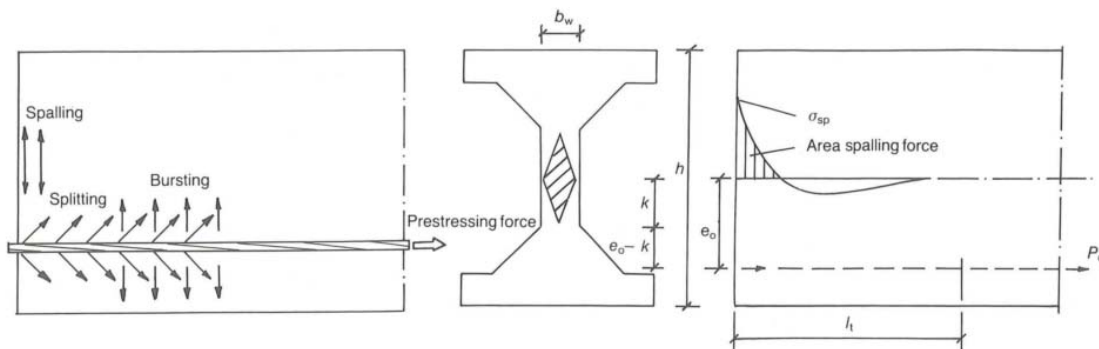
Spalling, Splitting y Bursting (FIP 1988)
